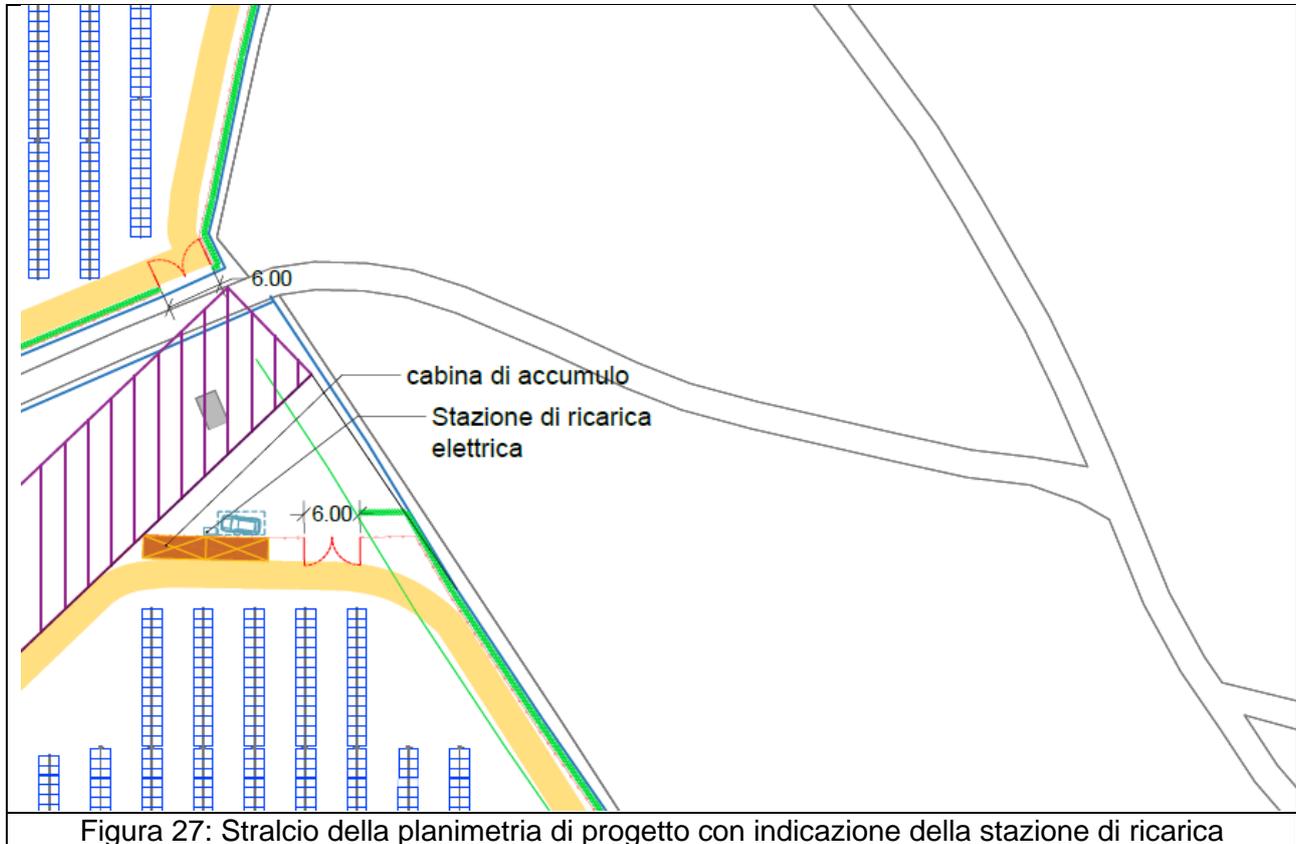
Stralcio della planimetria di progetto con indicazione della stazione di ricarica
